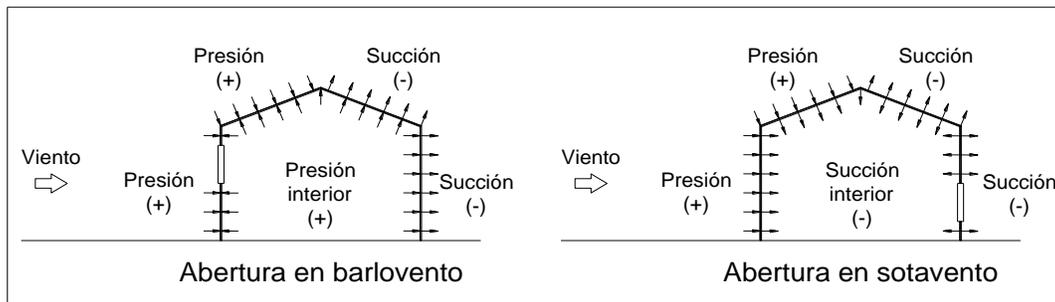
Convención de signos para las presiones ejercidas por el viento en una edificación con aberturas en barlovento o sotavento
